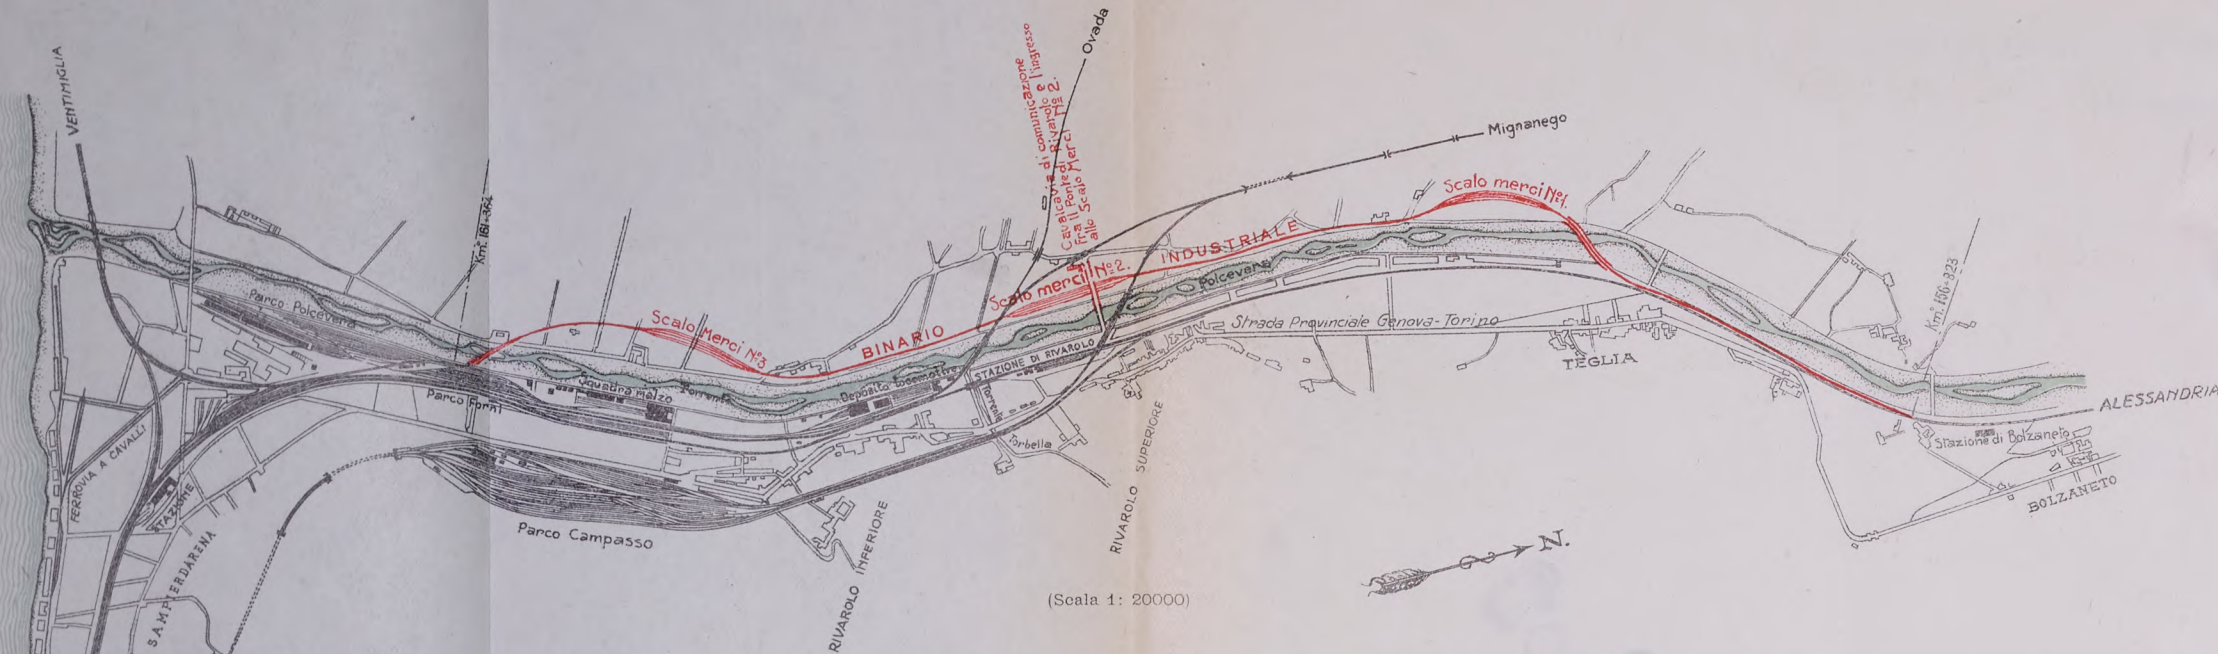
Pianta d'insieme del Cavalcavia e del Ponte di Rivarolo
